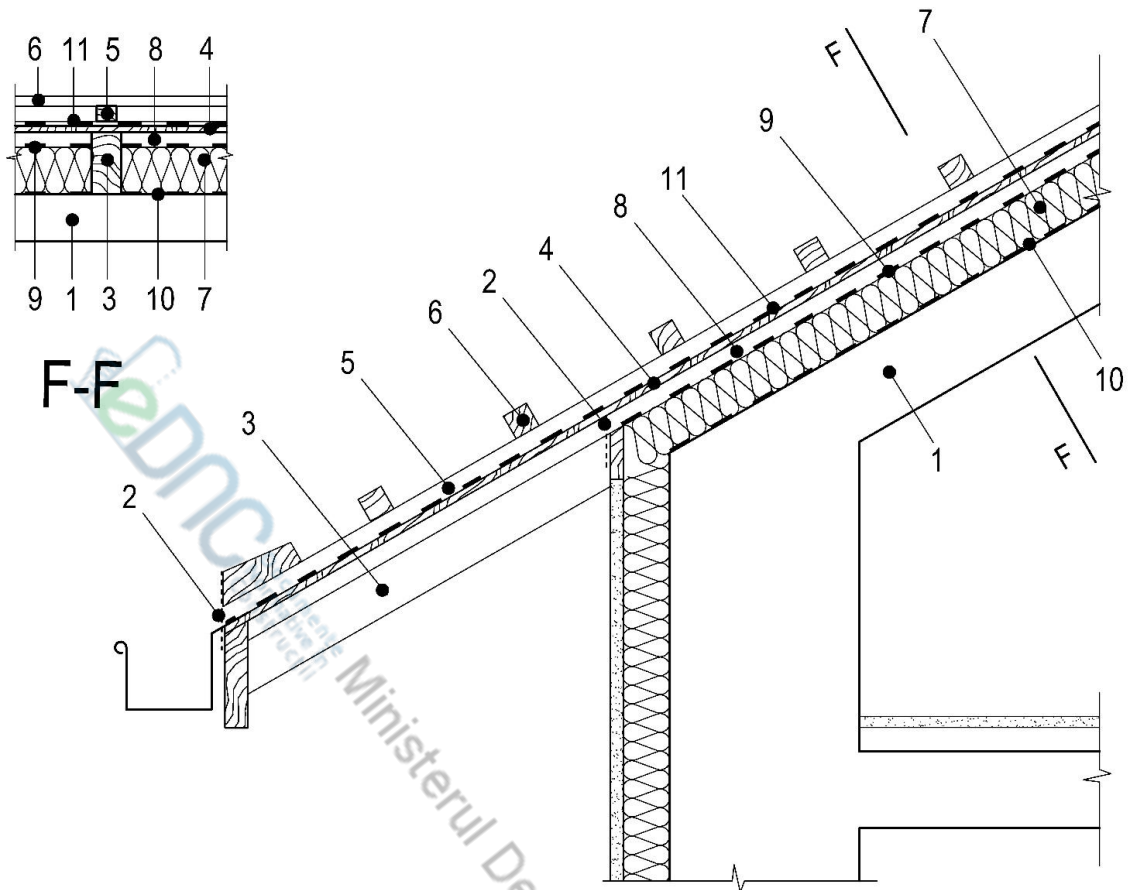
Мансардная крыша по наклонной железобетонной плите с теплоизолирующим слоем расположенным между стропилами
